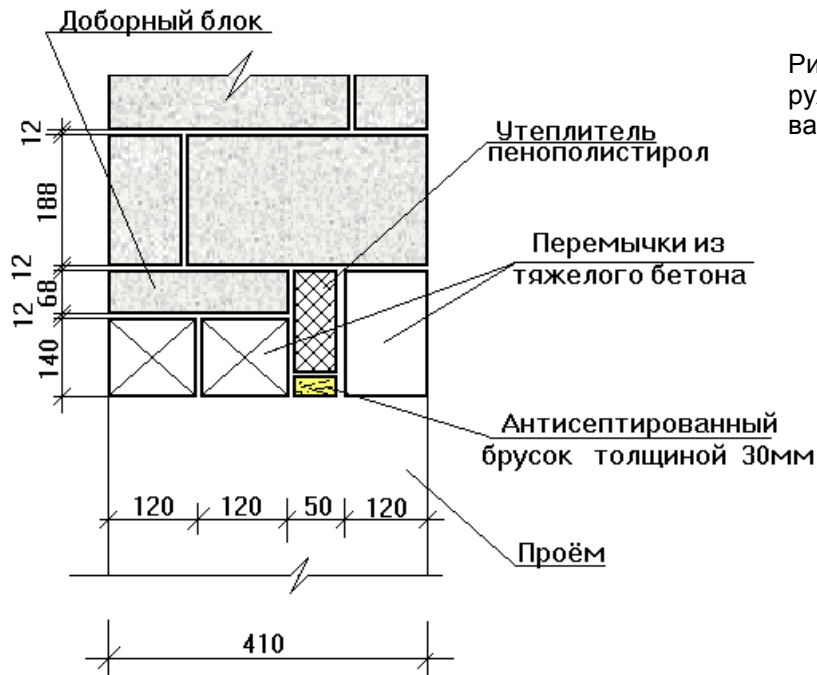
Пример выполнения проёма в наружной стене толщиной 410мм с использованием перемычек из тяжелого бетона.
